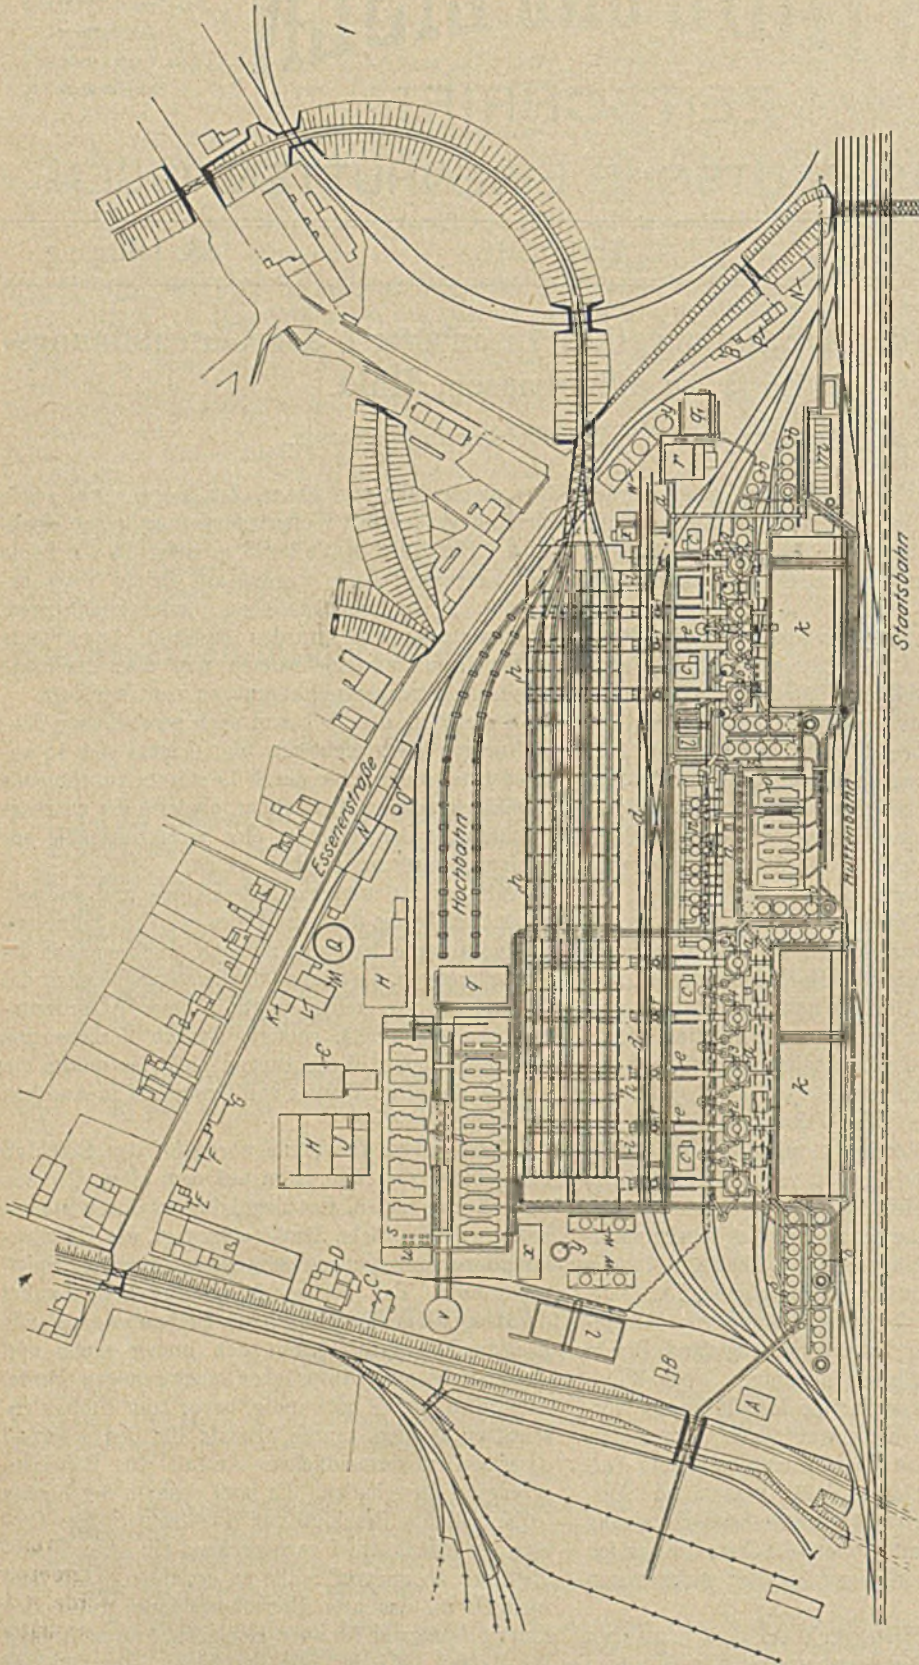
Lageplan der Eisenhütte I nach vollendetem Umbau.
